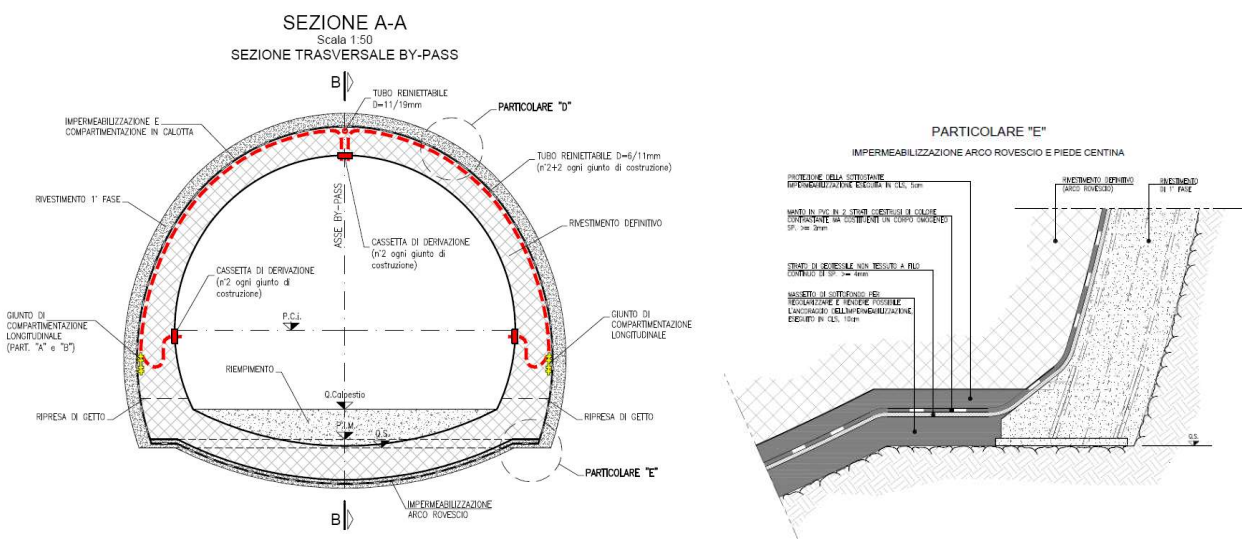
Sistema di impermeabilizzazione by-pass e particolare posa del telo di impermeabilizzazione in arco rovescio
